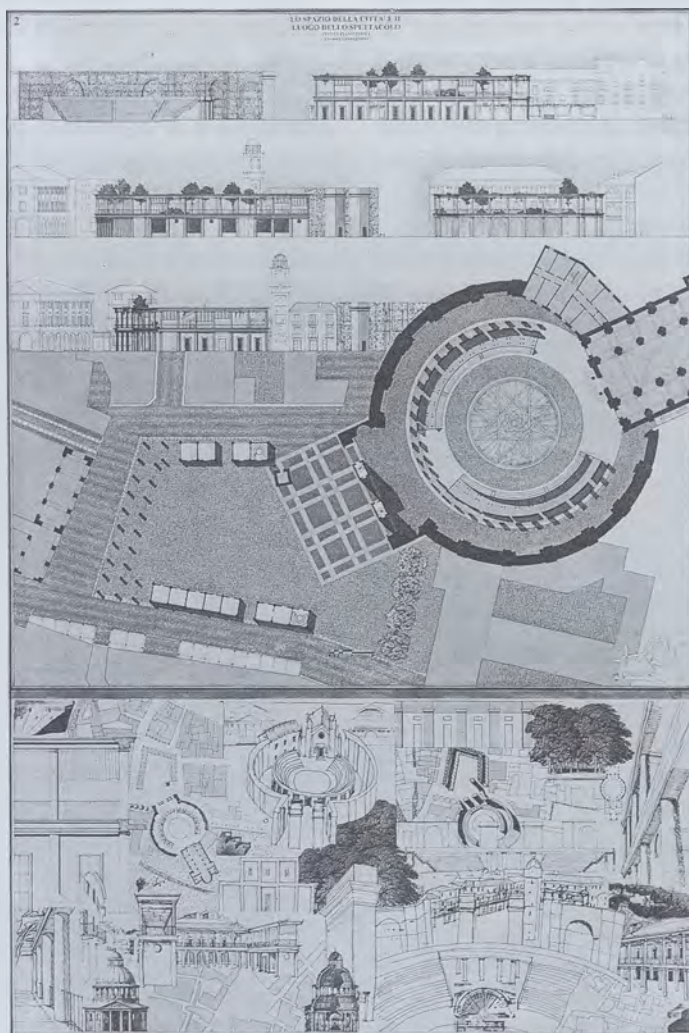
Pianta piano terra, prospetti, sezioni e studi.
